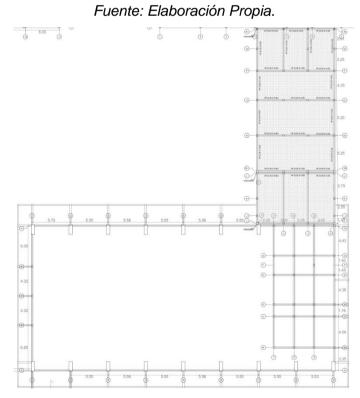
Plano de losas sector losa deportiva/SUM y tienda.
